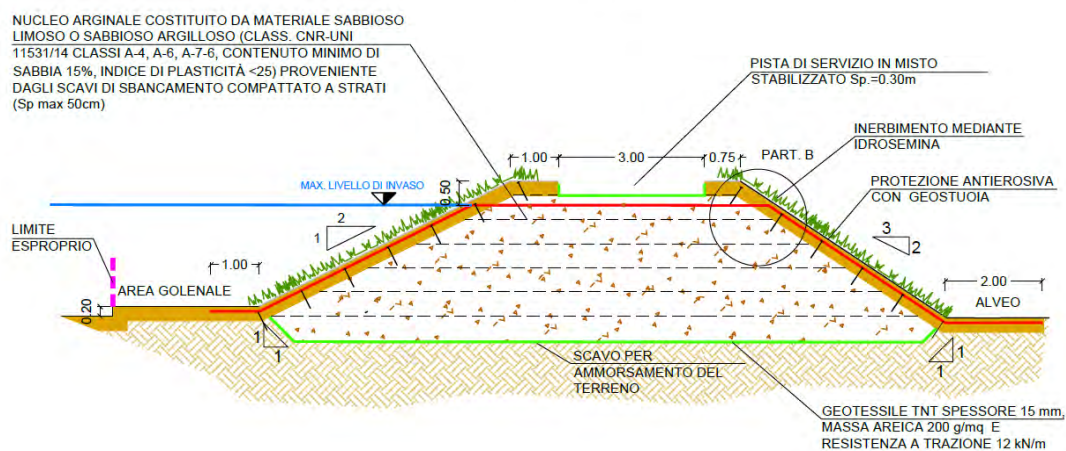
Sezione tipo di rilevato arginale con protezione antierosiva
